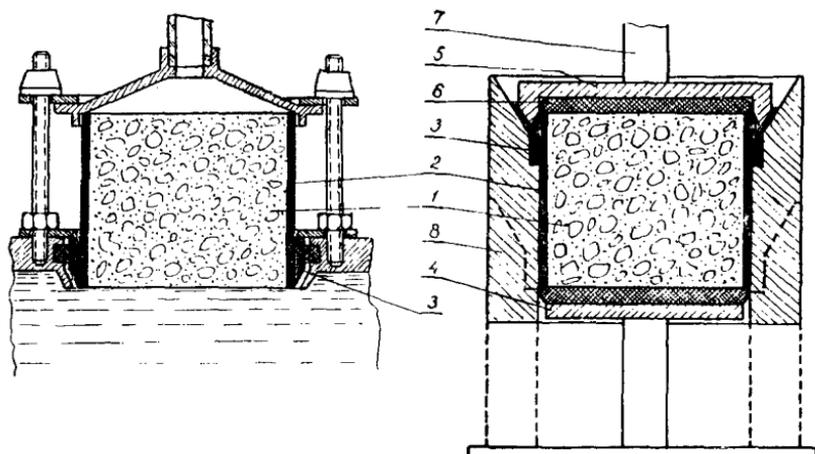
Схема подготовки бетонного образца к фильтрационным испытаниям. I — форма для гидроизоляции образца и формовая пояска; II — схема крепления образца в камере; III — образец цилиндрической формы; 2 — боковая гидроизоляция; 3 — жесткий пояс; 4 — подставка образца; 5 — прижимной диск; 6 — уплотнительный коврик; 7 — прижимной; 8 — стенки формы.
